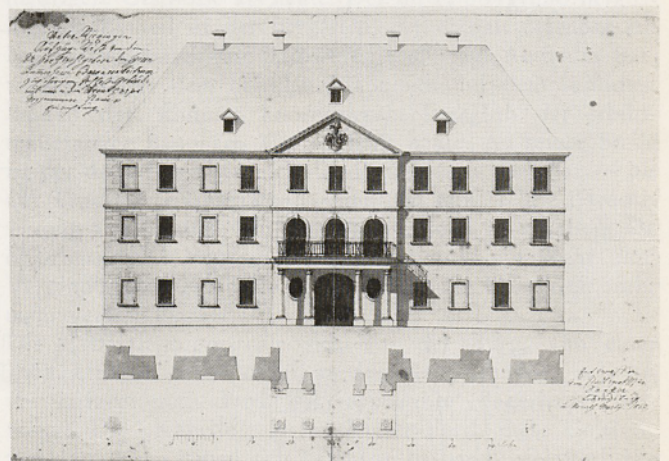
Schloß Unterriexingen. Änderungsvorschlag der Hauptfassade durch Danzer 1813 (Planverzeichnis 3)
